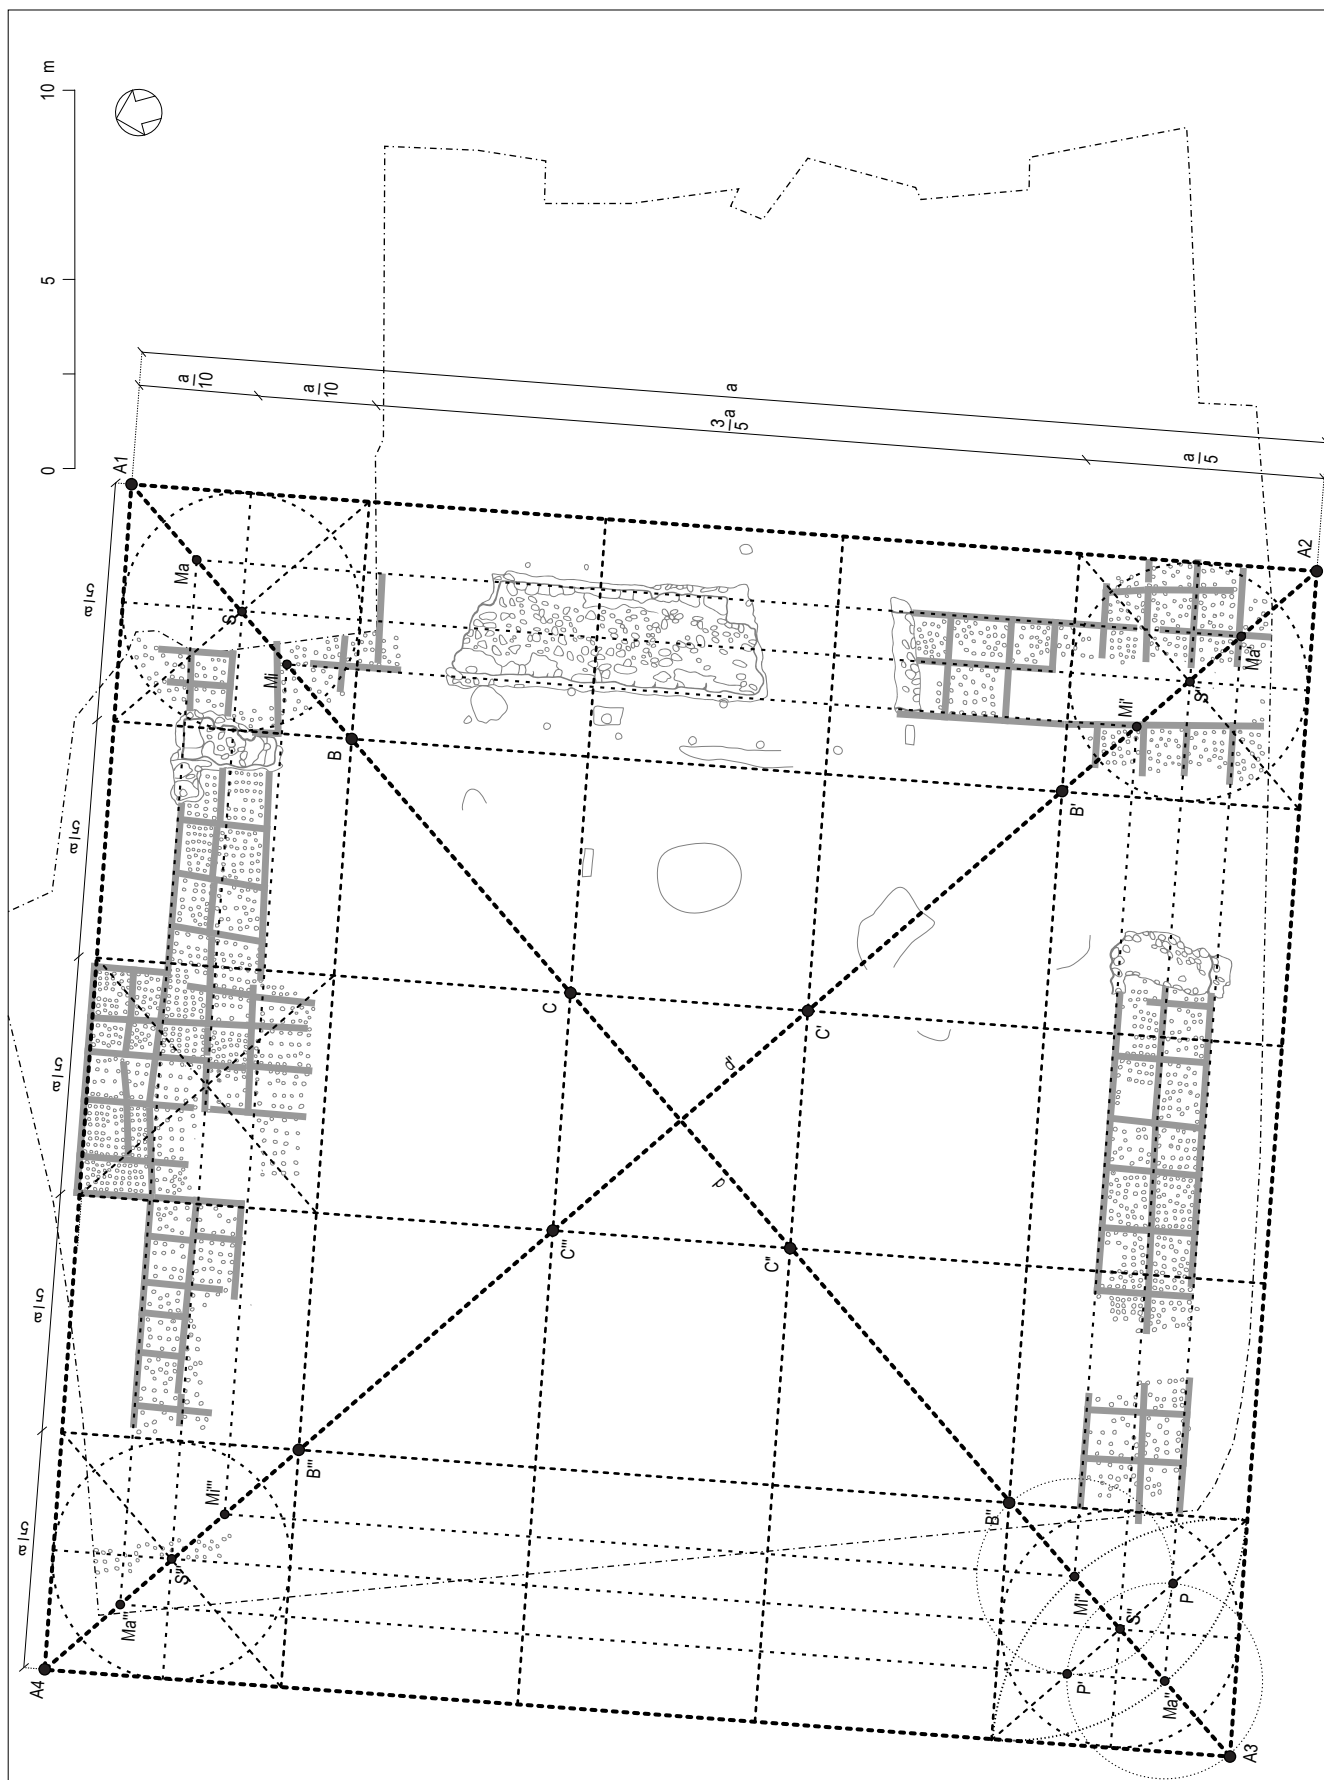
Kloten. Pfarreizentrum. Spätantike Befestigung. Interpretation Planungsschema Grundriss. M. 1:200.
